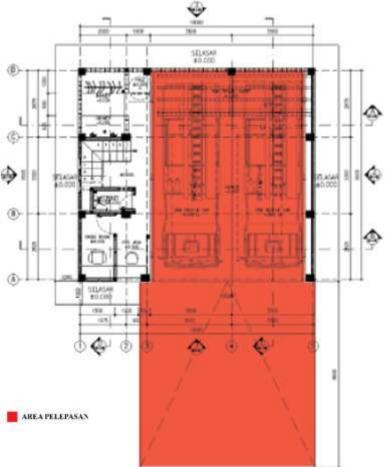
1 Tata Letak Ruang (site plan, zoning).
